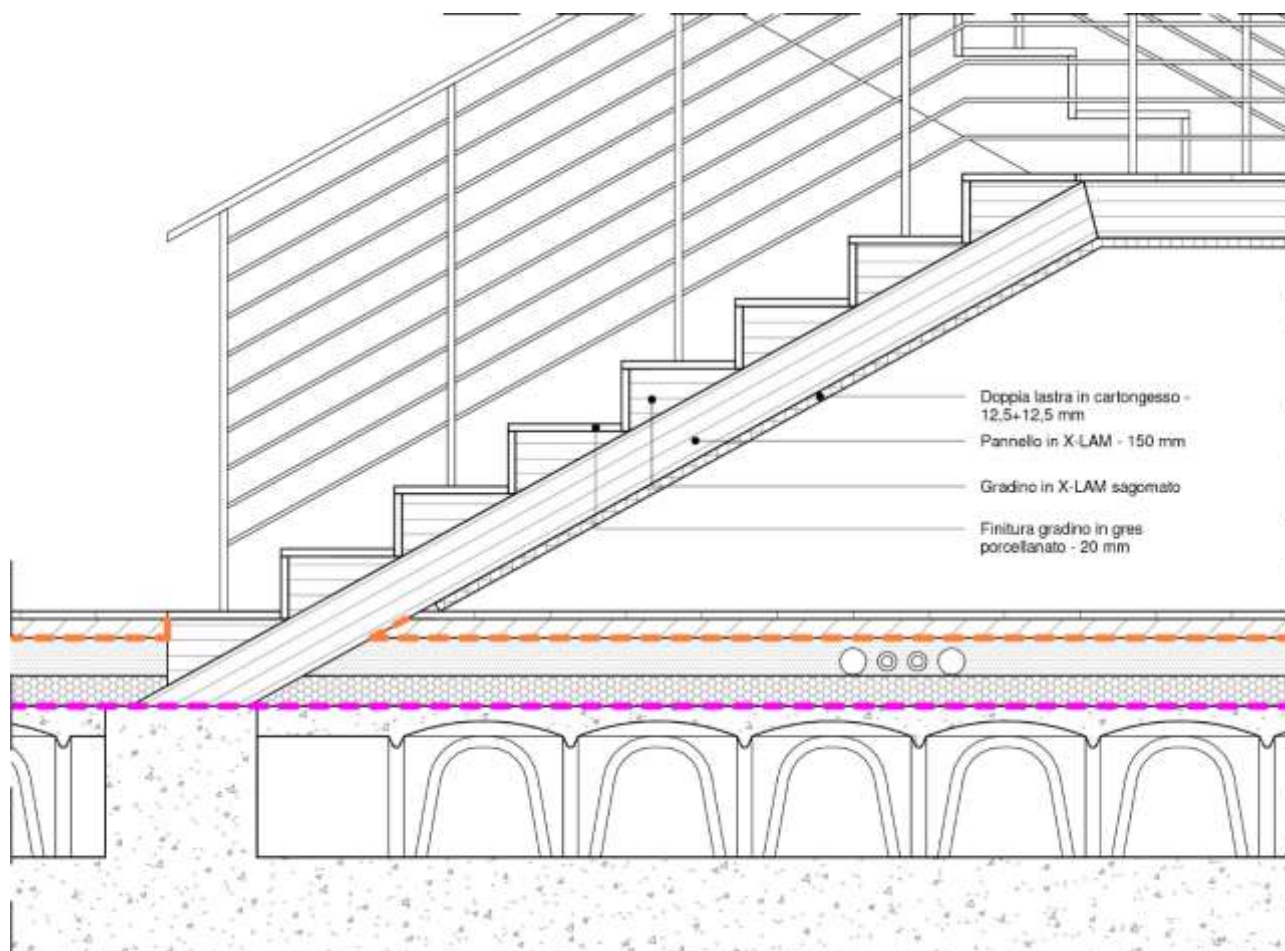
Dettaglio costruttivo scale dell'atrio d'ingresso - scala 1:20. [Fonte: elaborazione dell'autore]
